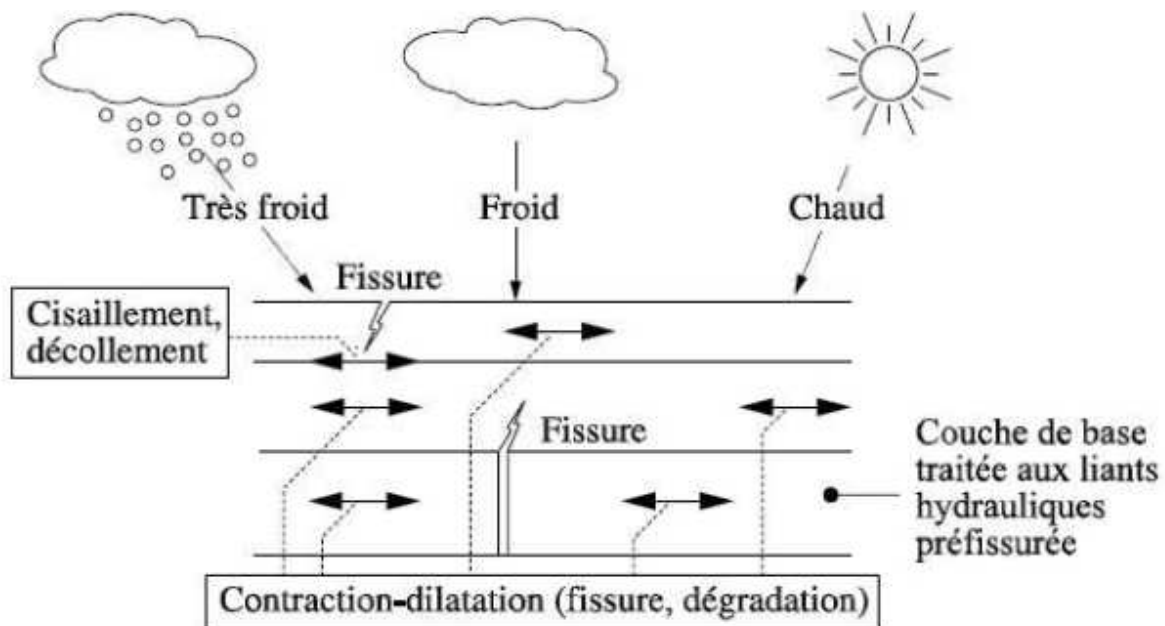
Effet de la température sur la structure de chaussée (Di Benedetto et Corté, 2005)
